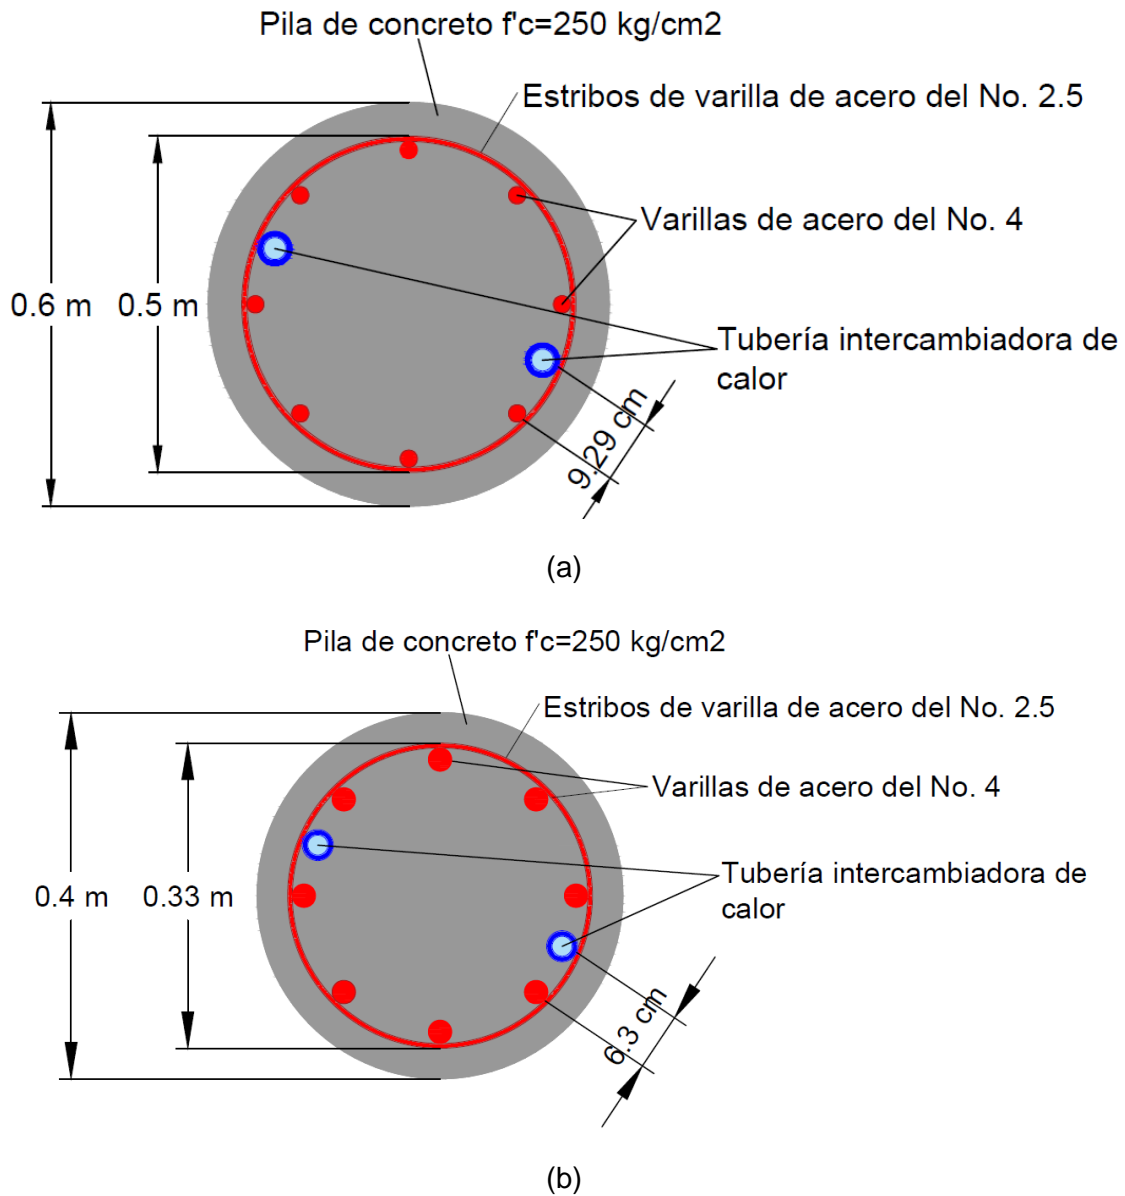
Detalle de la sección transversal de la pila de energía con tubería en U: (a) 60 cm de diámetro y (b) 40 cm de diámetro
